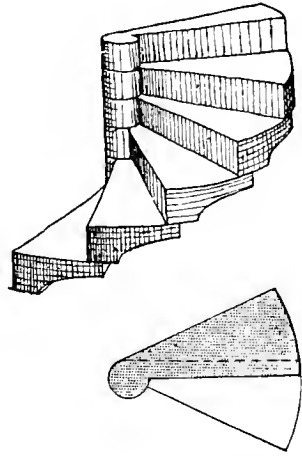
Détail d'un escalier en vis; plan et élévation perspective.
